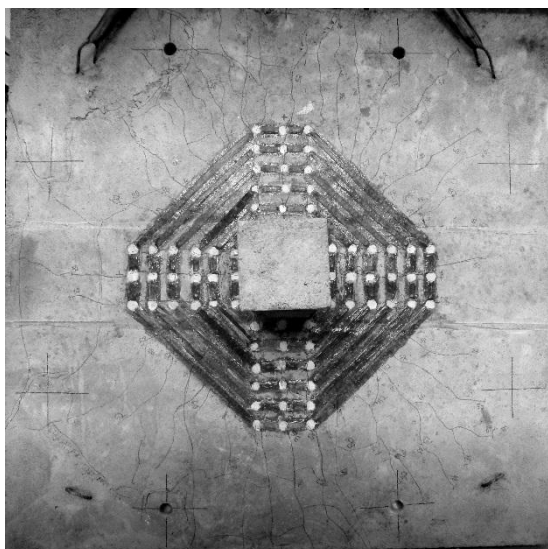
Padrão de Fissuração - LC-S2-6
